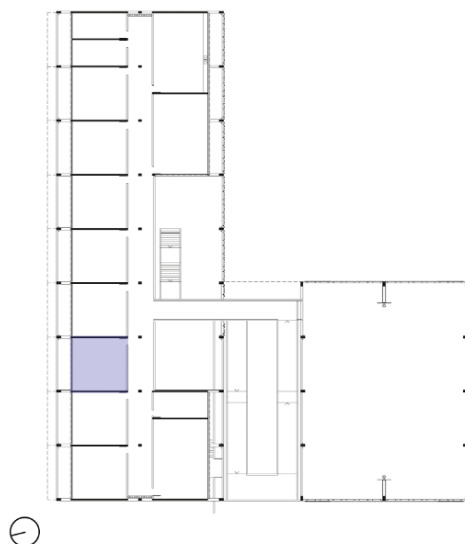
Imagem Planta segundo pavimento FDE Escola Estadual Votorantim com a sala de aulas do estudo. Fonte: Divulgação gruposp, 2008
